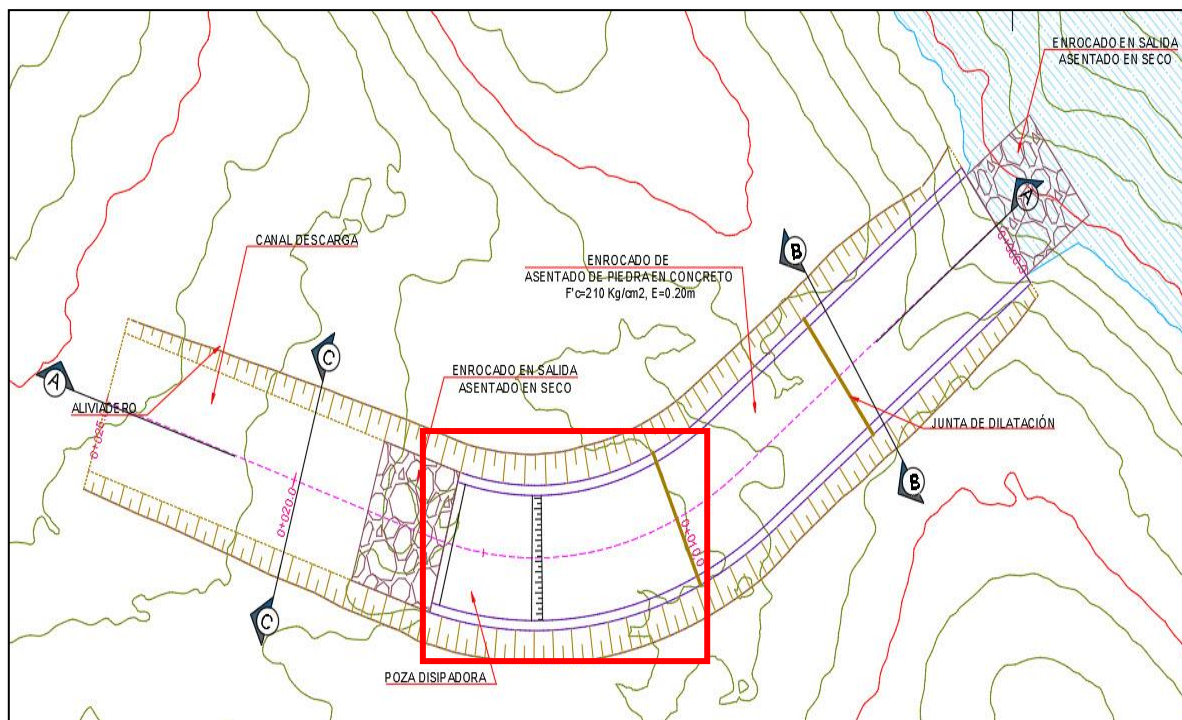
Detalle en planta de poza disipadora Qolpanaqocha long=2.5 m
